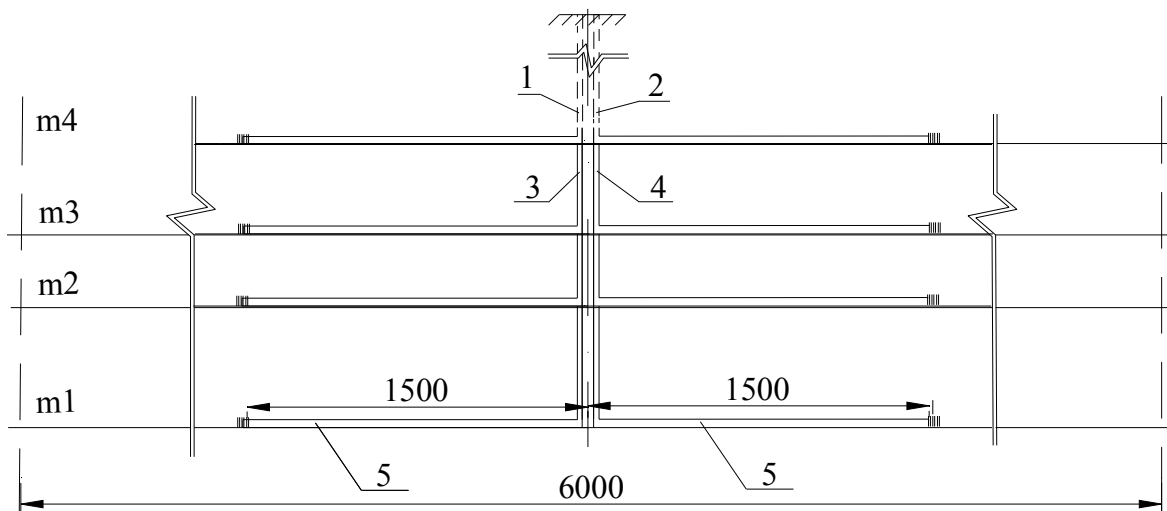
Горизонтальный разрез для примера схемы вскрытия и подготовки шахтного поля на уровне транспортного горизонта (разрез А – А на рис. 1.2): 1 – главный наклонный ствол; 2 – путевой наклонный ствол; 3 – конвейерный квершлаг; 4 – путевой (воздухоподающий) квершлаг; 5 – панельные (основной) конвейерный и путевой штреки
